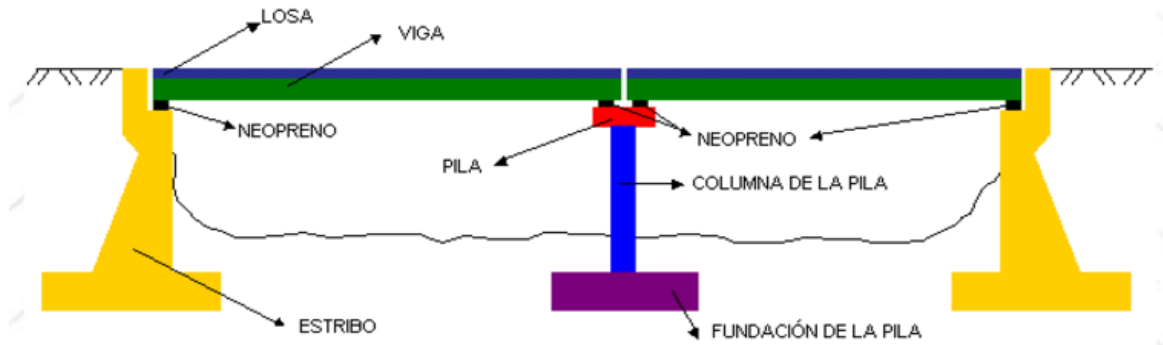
Esquema de los elementos que conforman la superestructura y subestructura.
